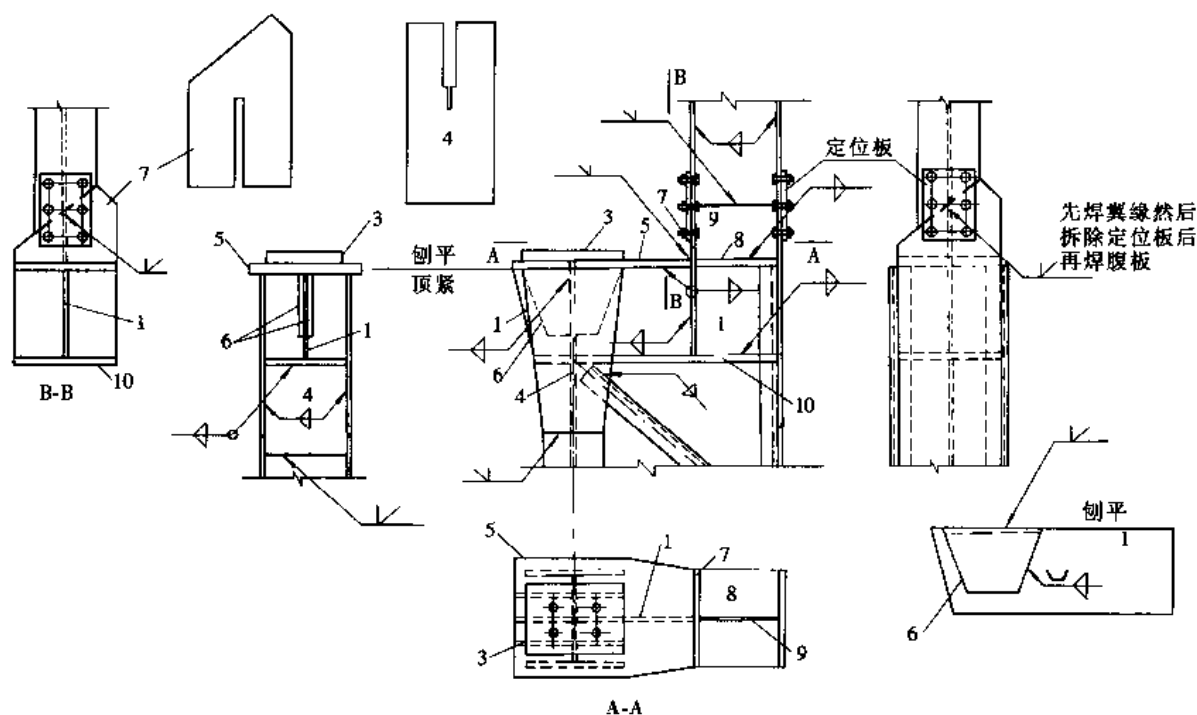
单壁式肩梁 (柱肢为焊接工字钢)
